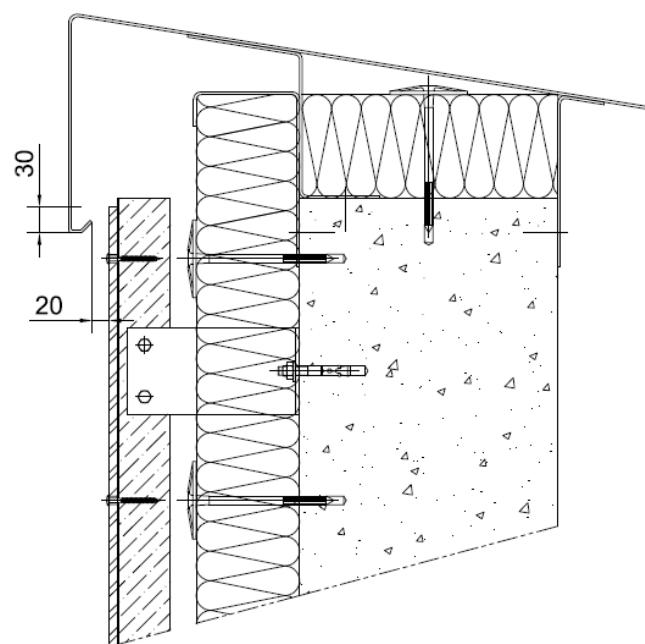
Sección vertical. Detalle de coronación sobre parapeto.
